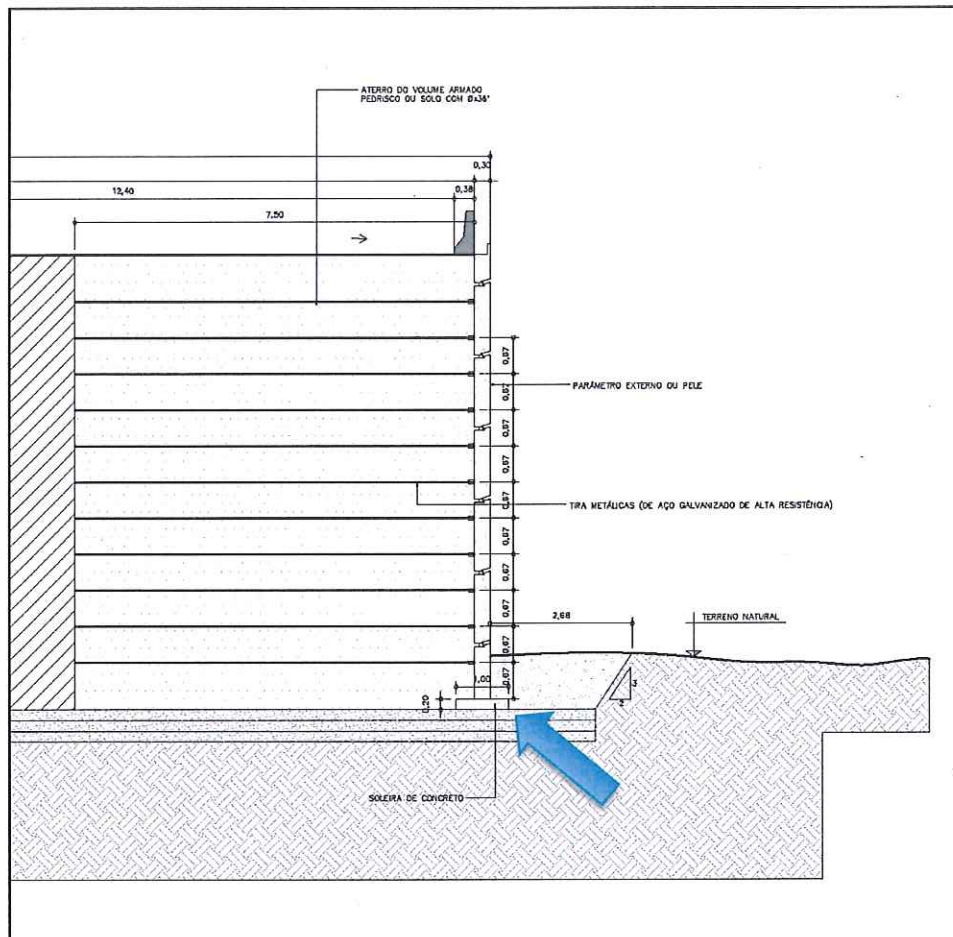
Detalhe do aterro armado (Extraído do projeto executivo)
